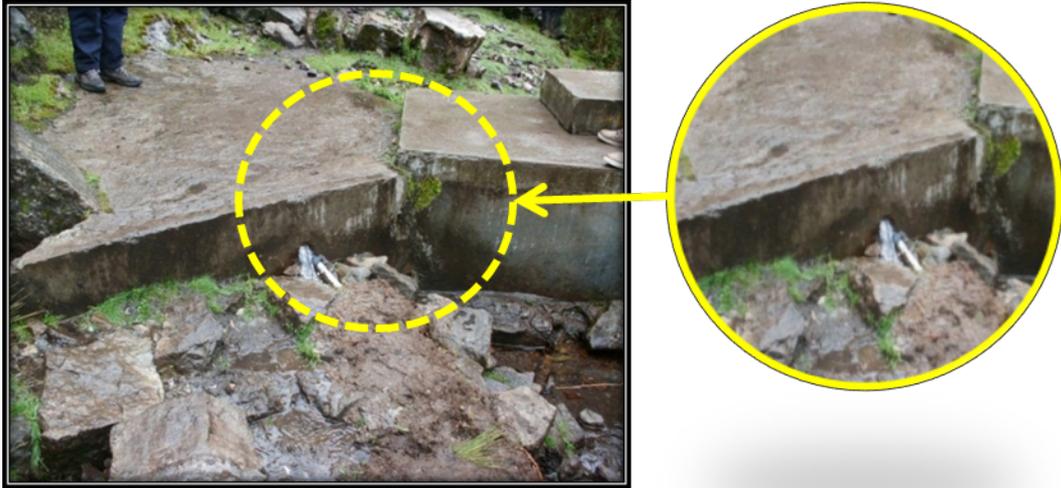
Vista de la captación occechacca con presencia de fisuras y en estado regular.
